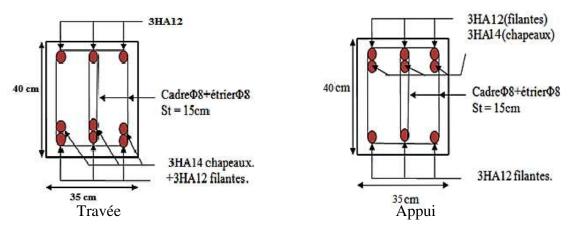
Schéma de ferraillage des poutres principales de terrasse.
